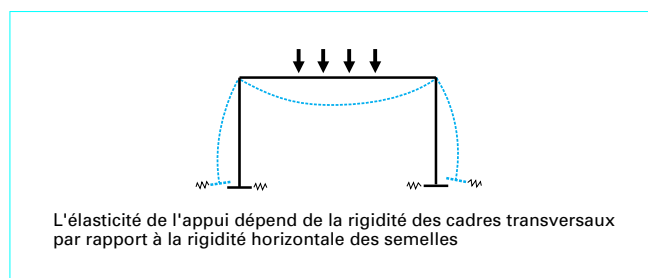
Liaison élastique entre cadre et semelles des poutres
